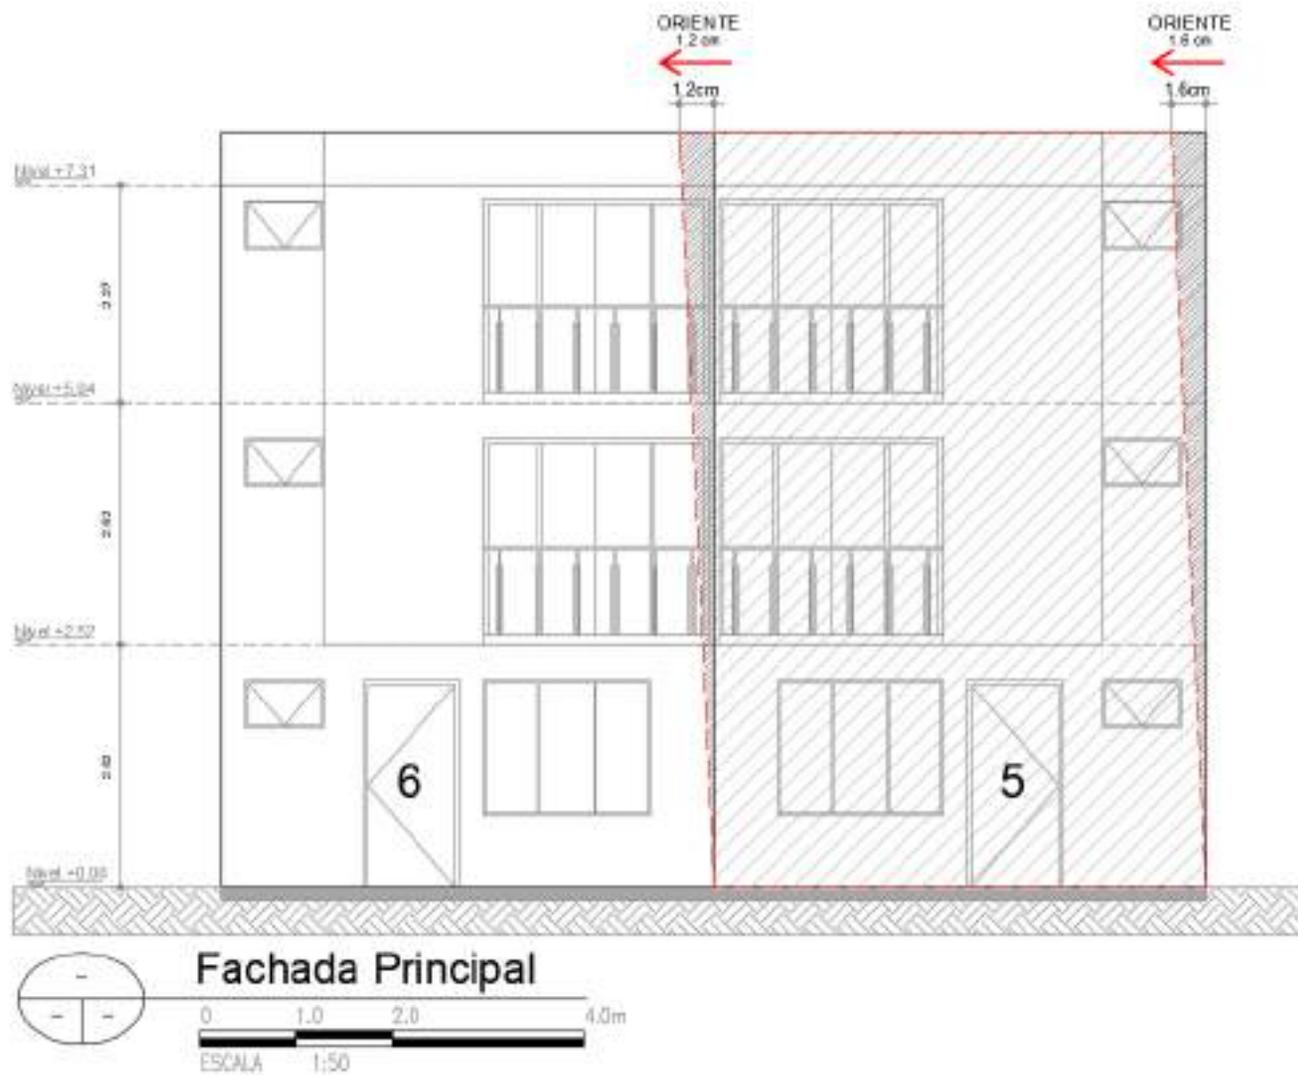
Verticalidad en fachada principal de la Casa No. 5
